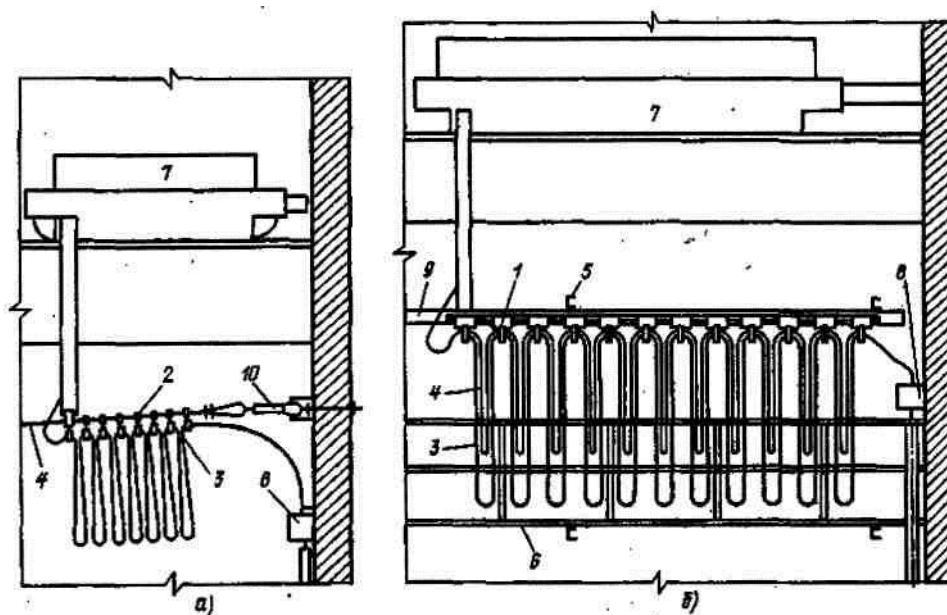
Питание передвижных механизмов гибким кабелем:
